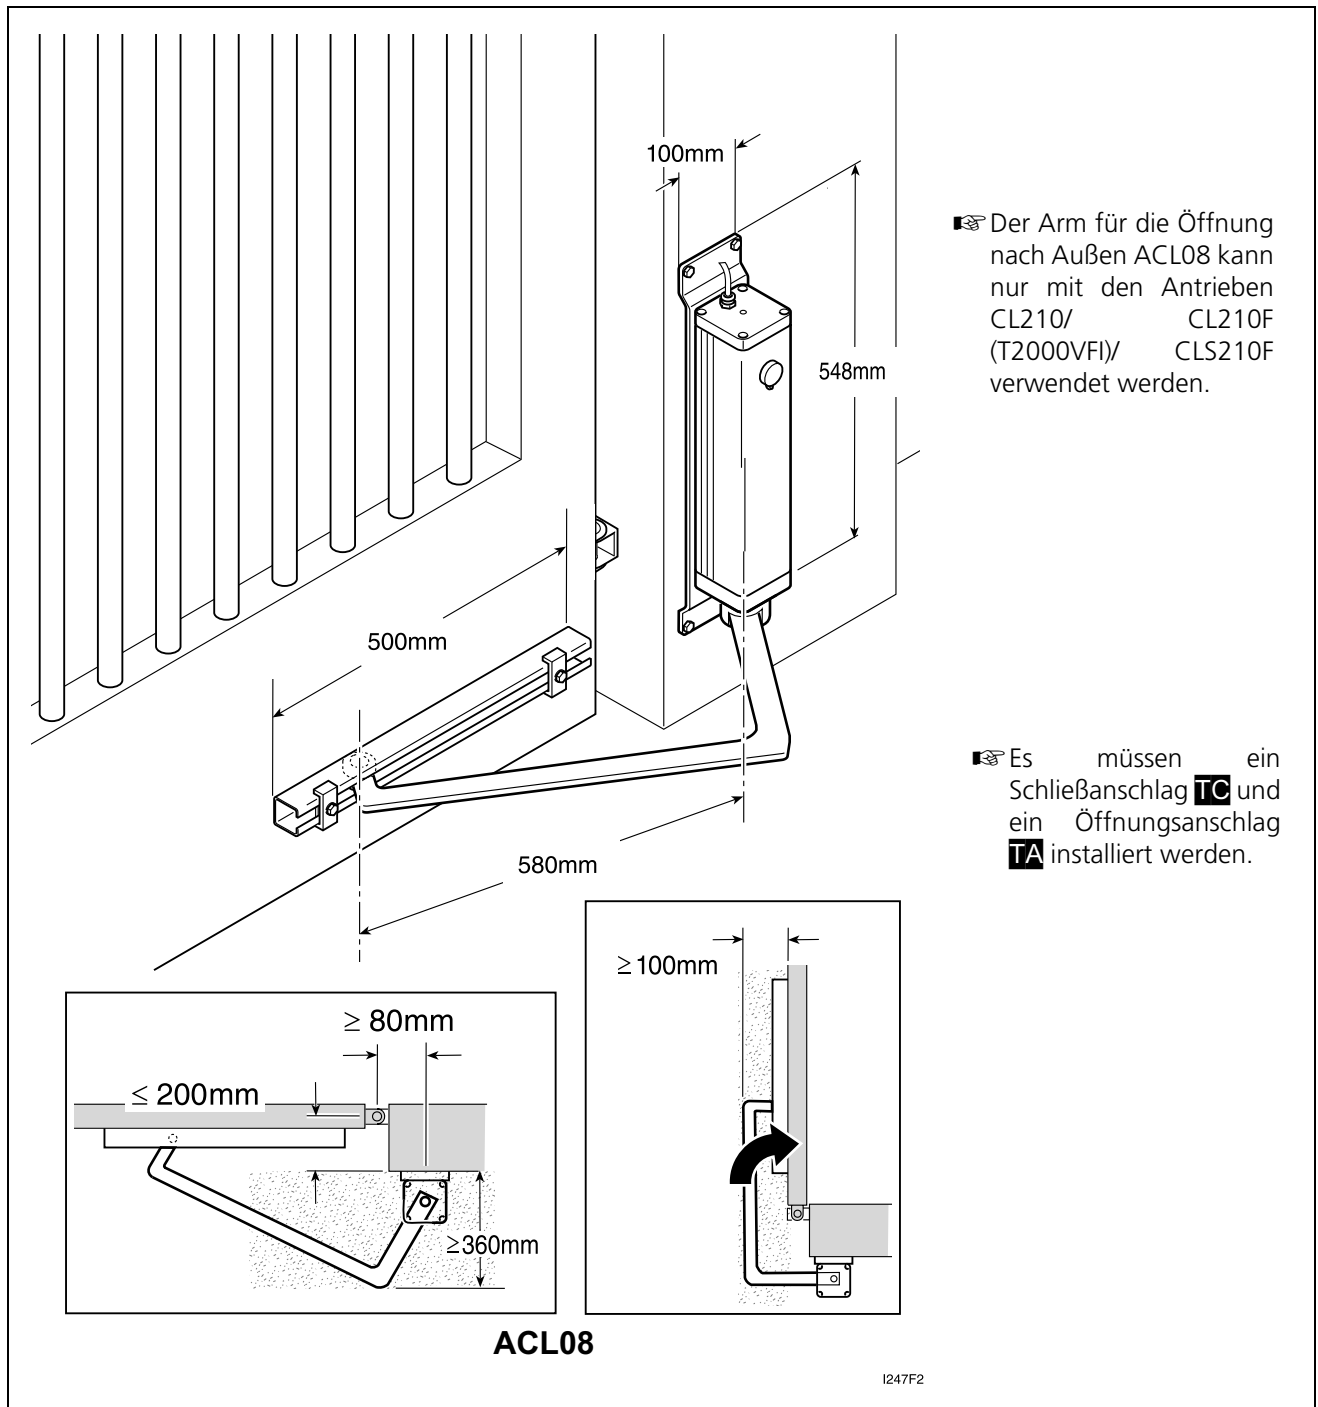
Beispiel für die Montageposition mit Schiebearm für Öffnung nach Außen
